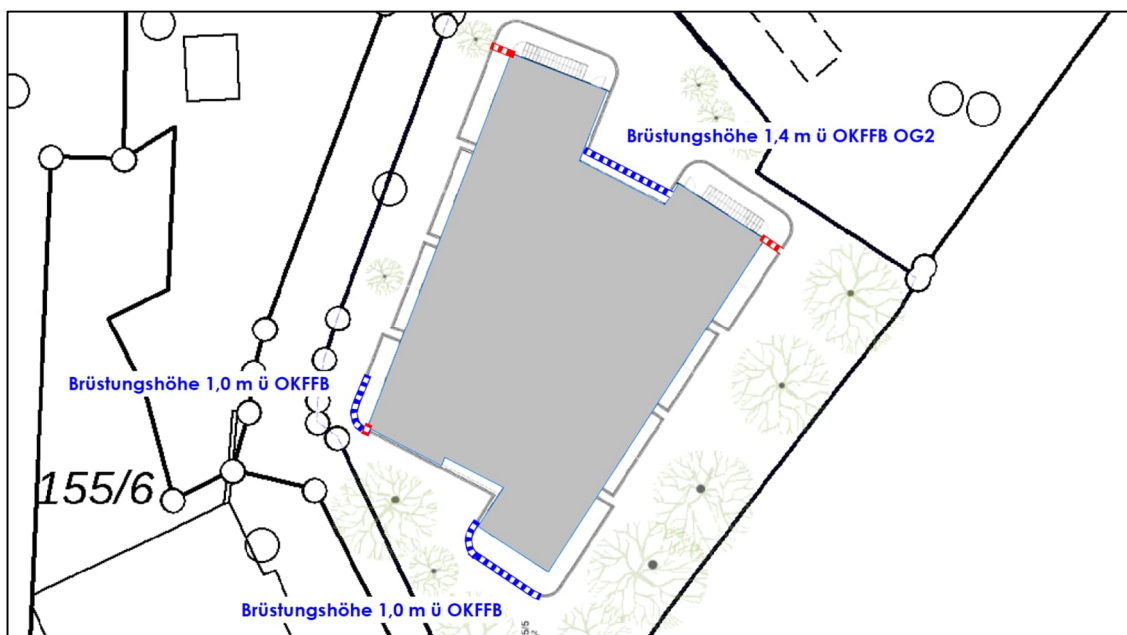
Lageplan /28, 40/ mit Darstellung der berücksichtigten Abschirmungen
